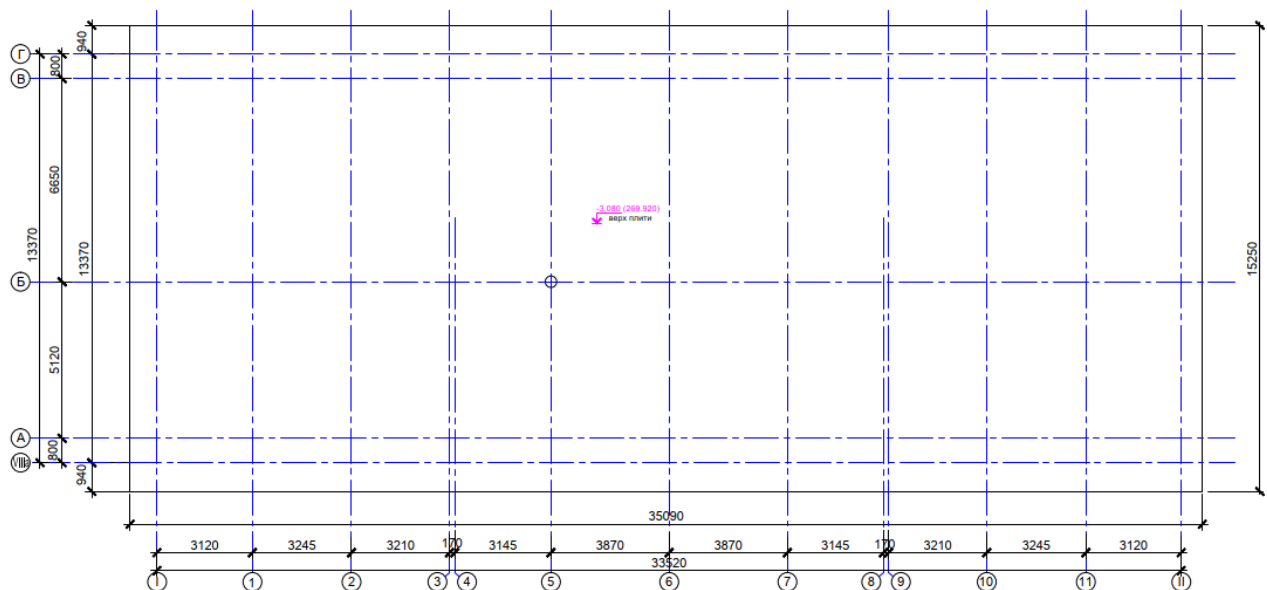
Опалубочний план фундаментної монолітної залізобетонної плити на відм. низу -3,580 м
